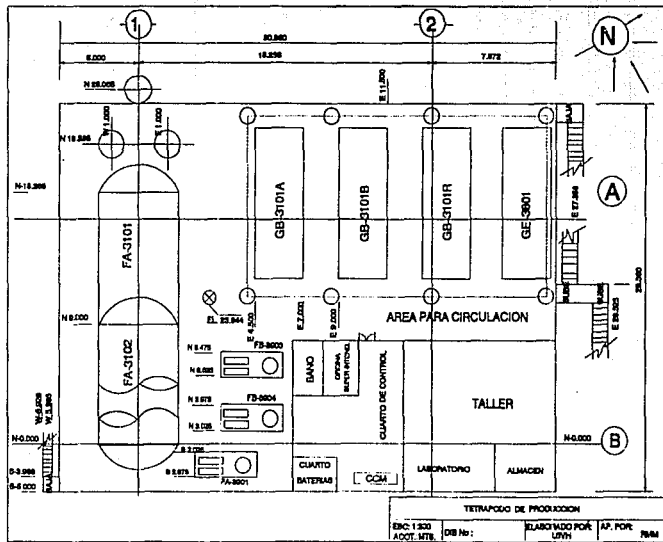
PLANO DE LOCALIZACION GENERAL DE EQUIPO
